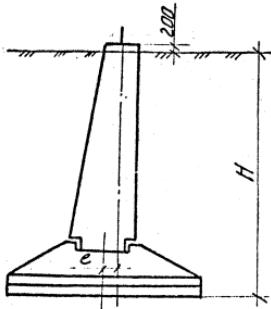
Схема установки унифицированных фундаментов под одну опору
